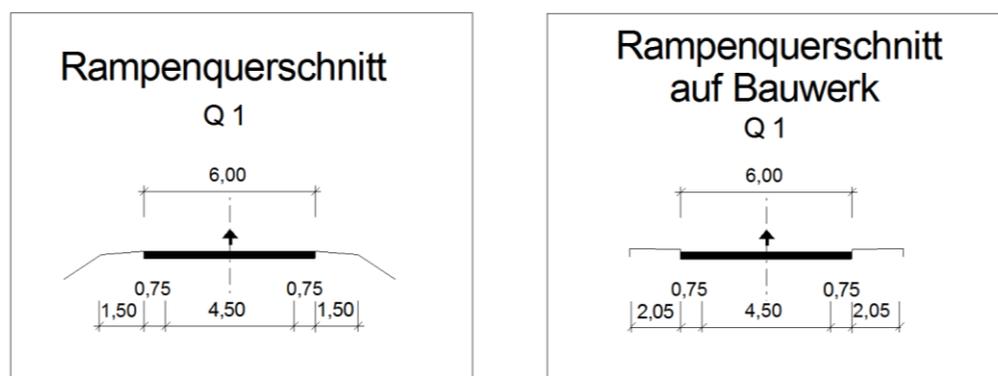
geplanter Rampenquerschnitt Q1 für das Bauwerk BS 1 RQ 28
